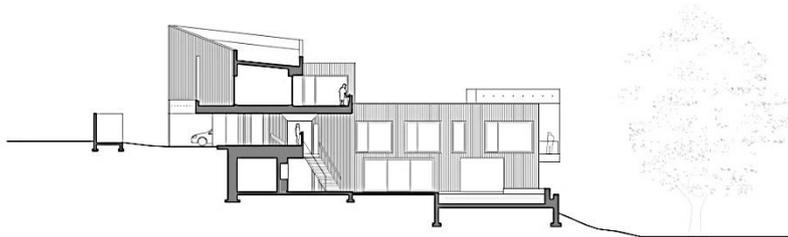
Planta baixa e Cortes da Astrid Hill.
